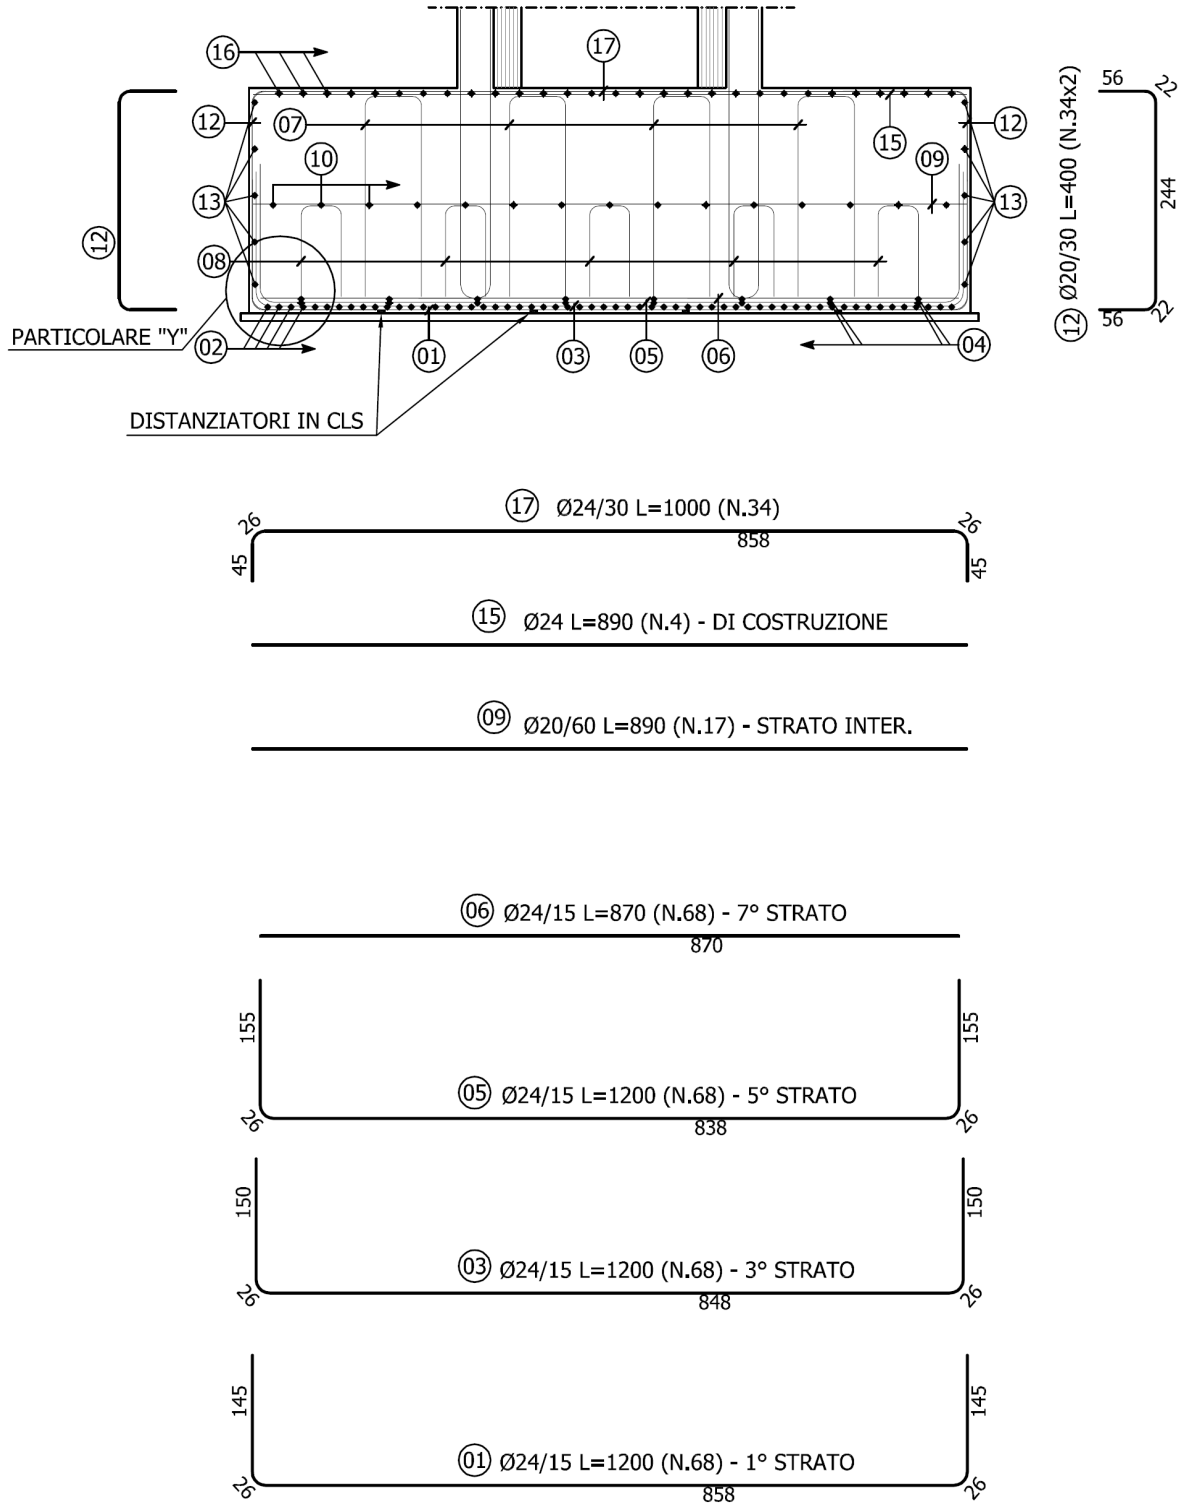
Armatura della fondazione della pila: sezione longitudinale
